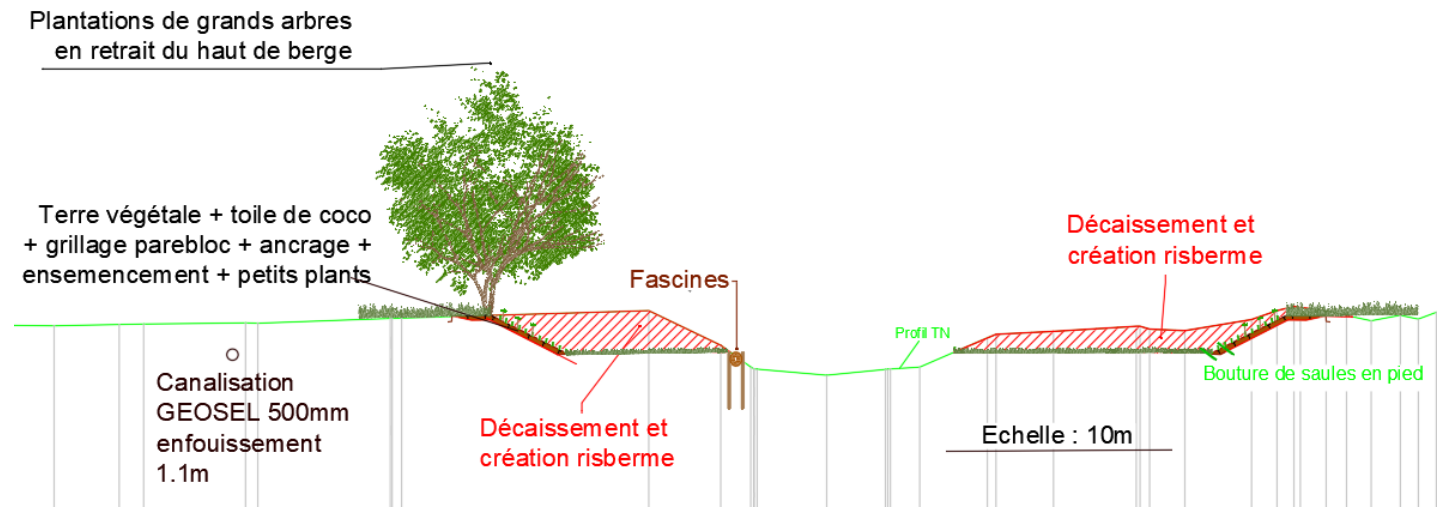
Secteur 4 – Action 8, profil type P09 (élargissement par rive gauche et par rive droite)
